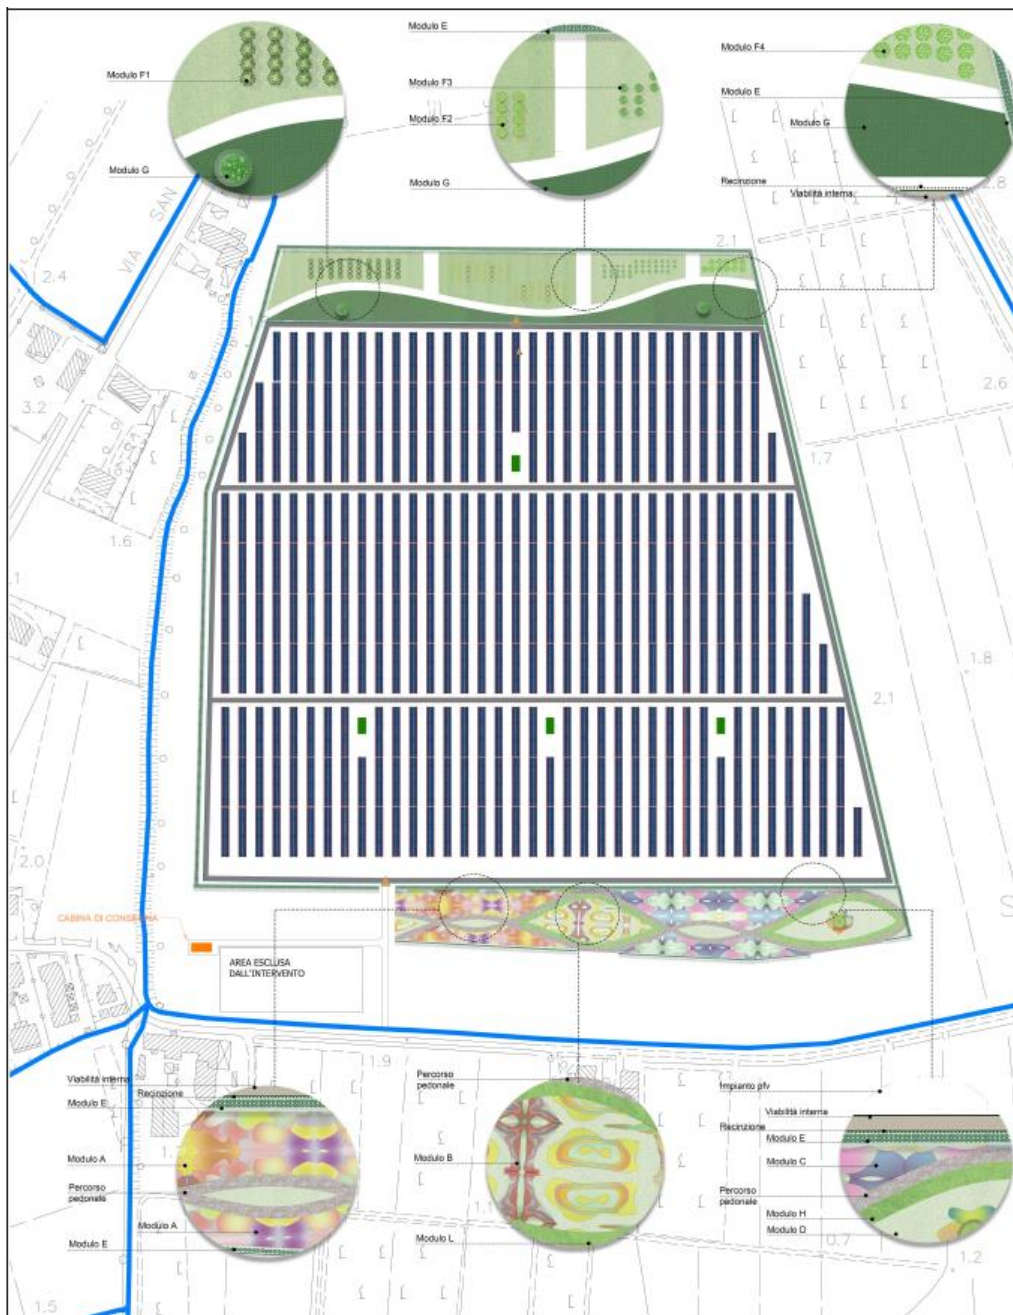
Planimetria generale dell'impianto completa delle sue opere di mitigazione paesaggistica.
